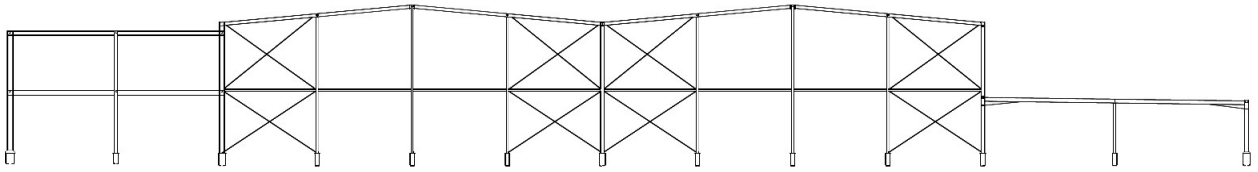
Esquema del pórtico trasero de la estructura proyectada.
